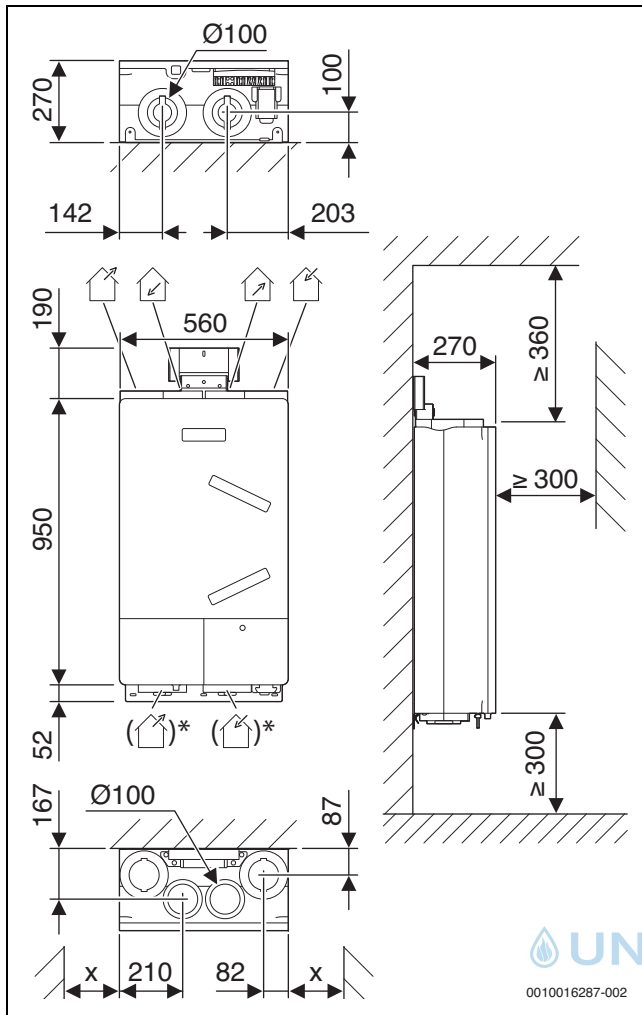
Abmessungen und Mindestabstände Wandinstallation Vent 4000 CC
